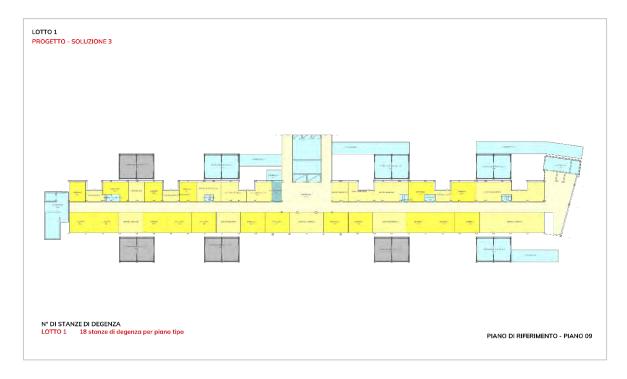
PROGETTO PIANO TIPO LOTTO 1 - SOLUZIONE 3
